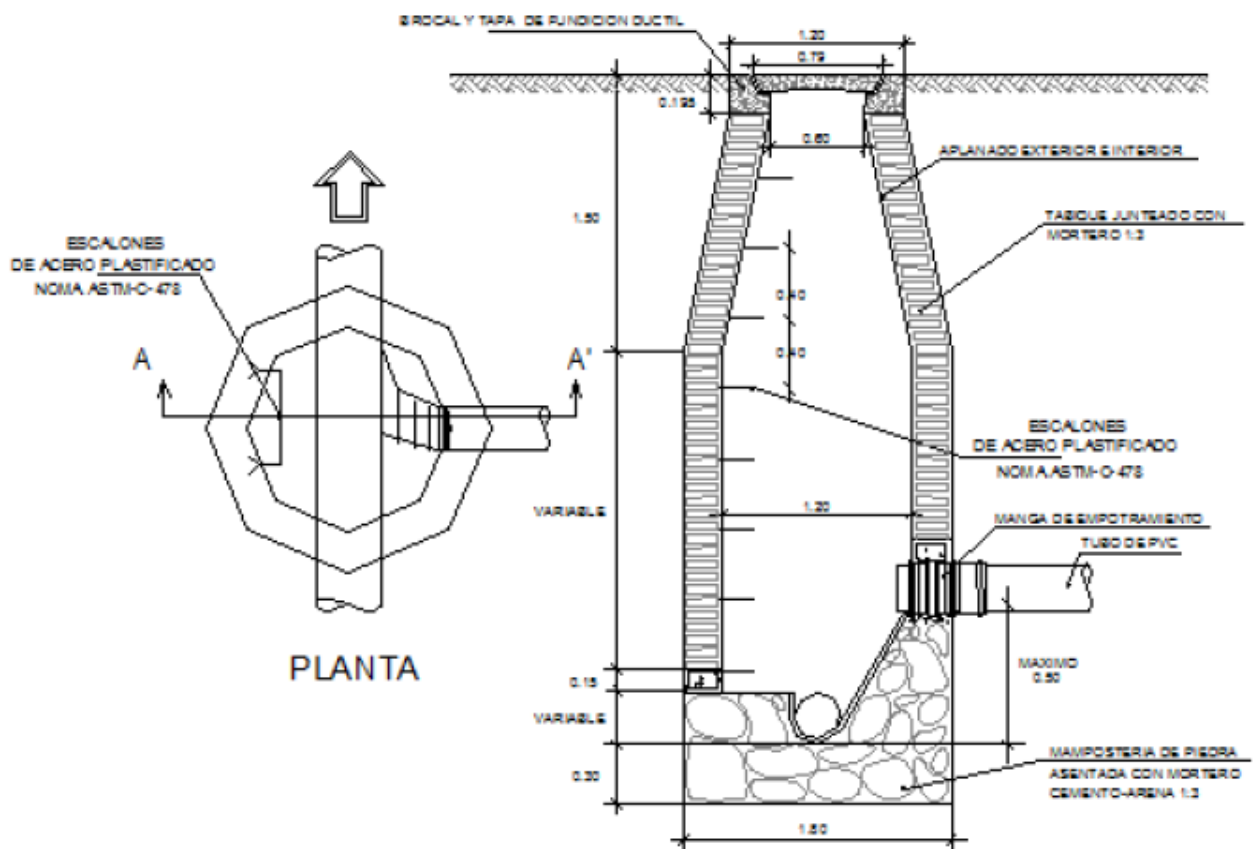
Pozo de Visita con Estructura de Caída Libre
